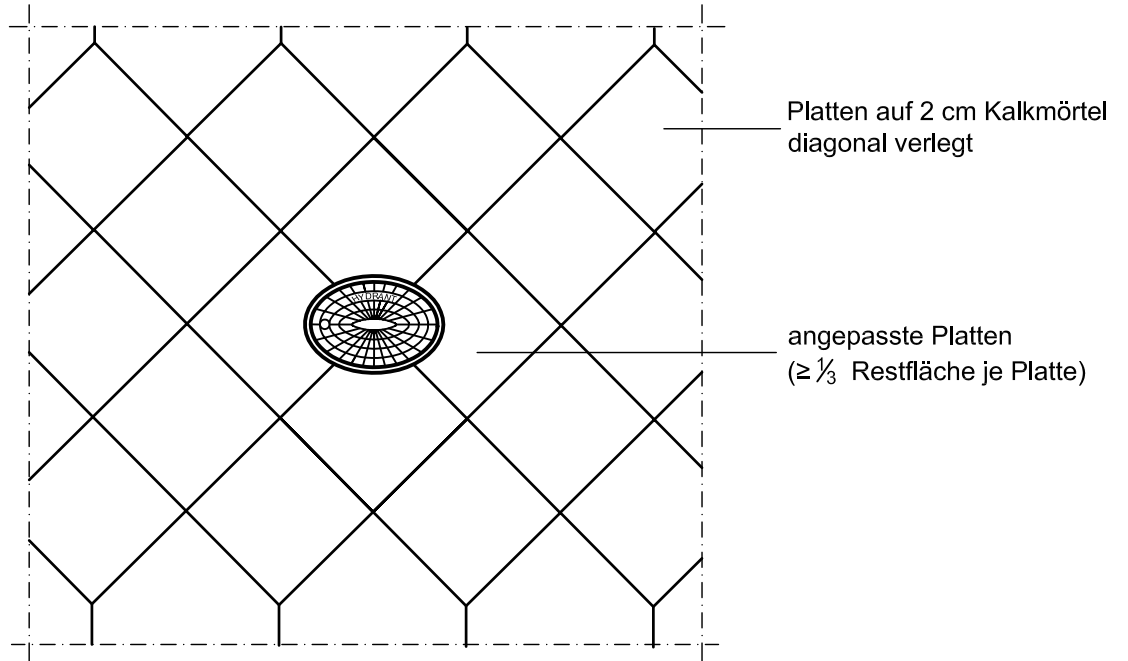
Hydrantenstraßenkappe eingepasst in Plattenbahn
